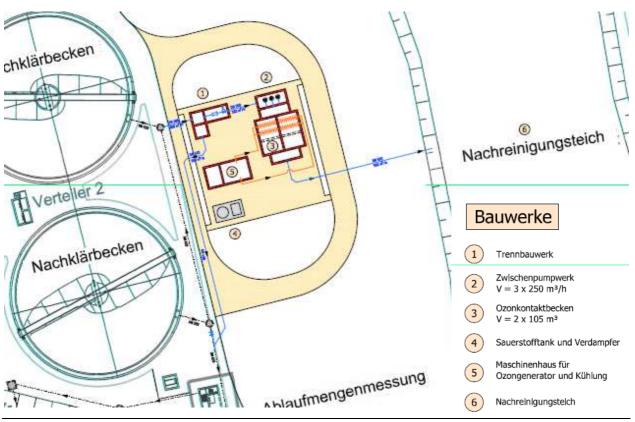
Variante 3 (Ozon), Lageplanausschnitt
